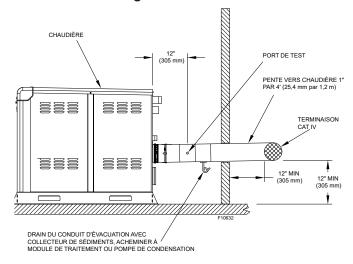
PVC/CPVC - Ventilation murale et horizontale
